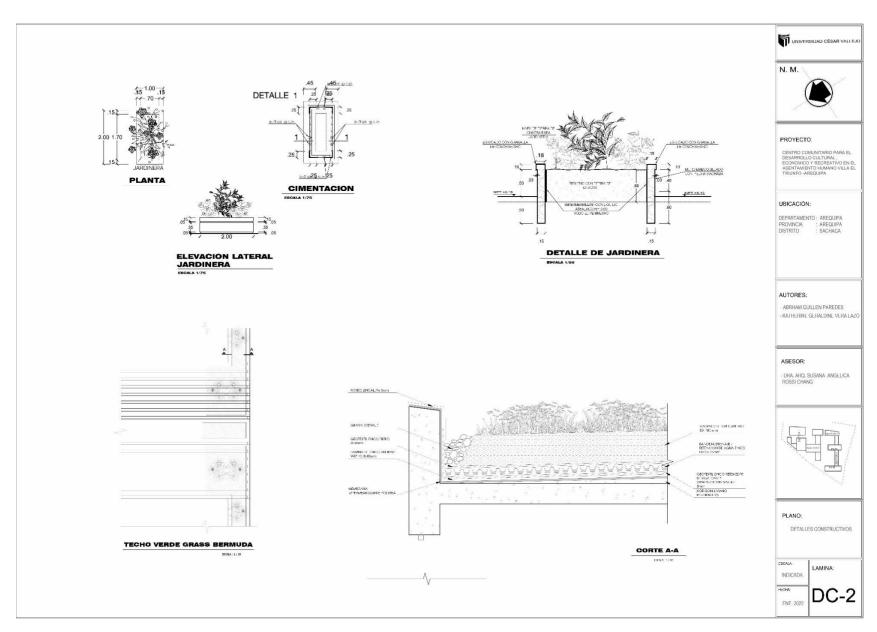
Plano de Detalles Constructivos (Techo verde, Jardinera) - Elaboración propia
